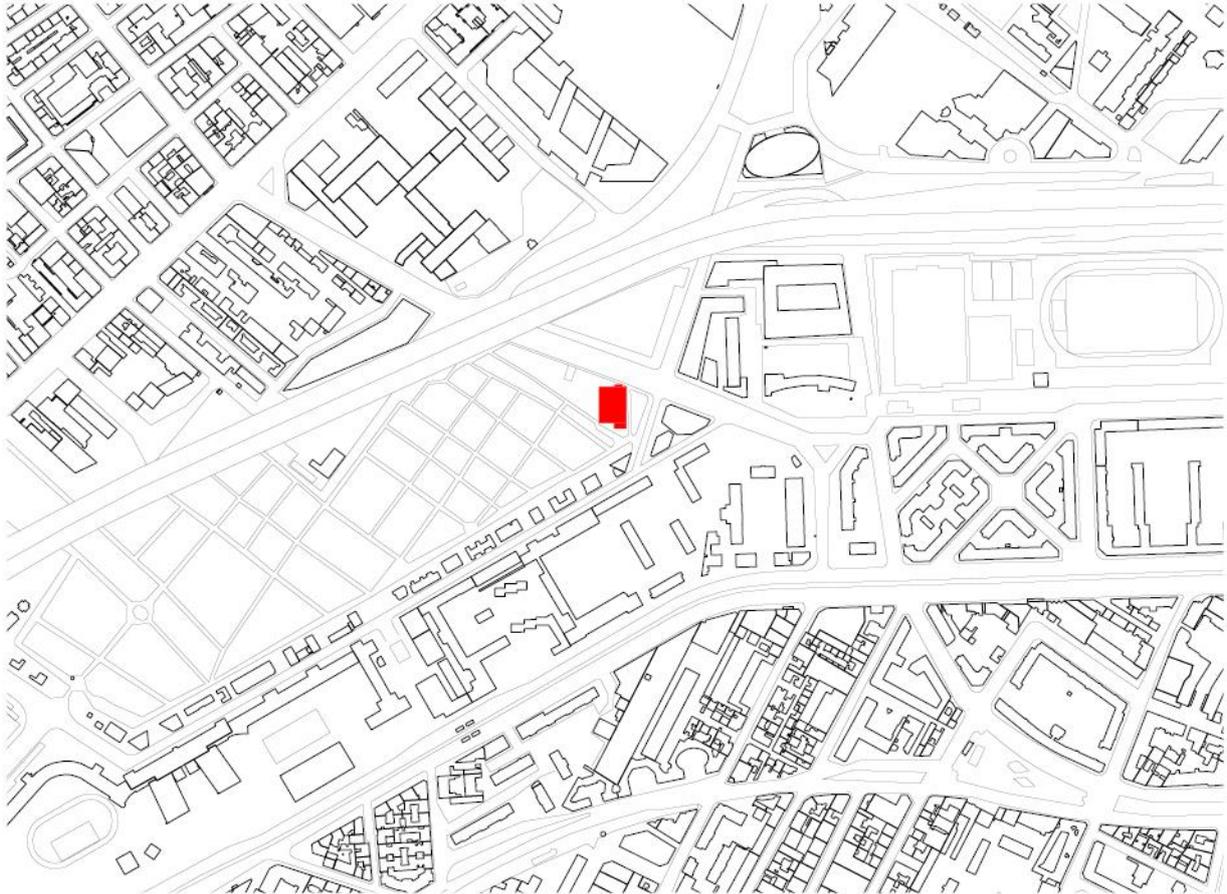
Plan d'implantation Tour Bois le Prêtre
